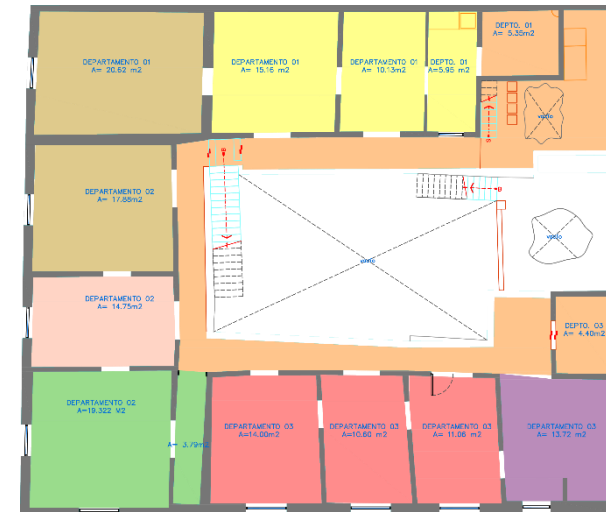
, 3.4, 3.5 Plantas de levantamiento y áreas de espacios en planta baja, alta y de azotea respectivamente Fuente: Elaboración propia con el equipo de ReGenera Espacio
